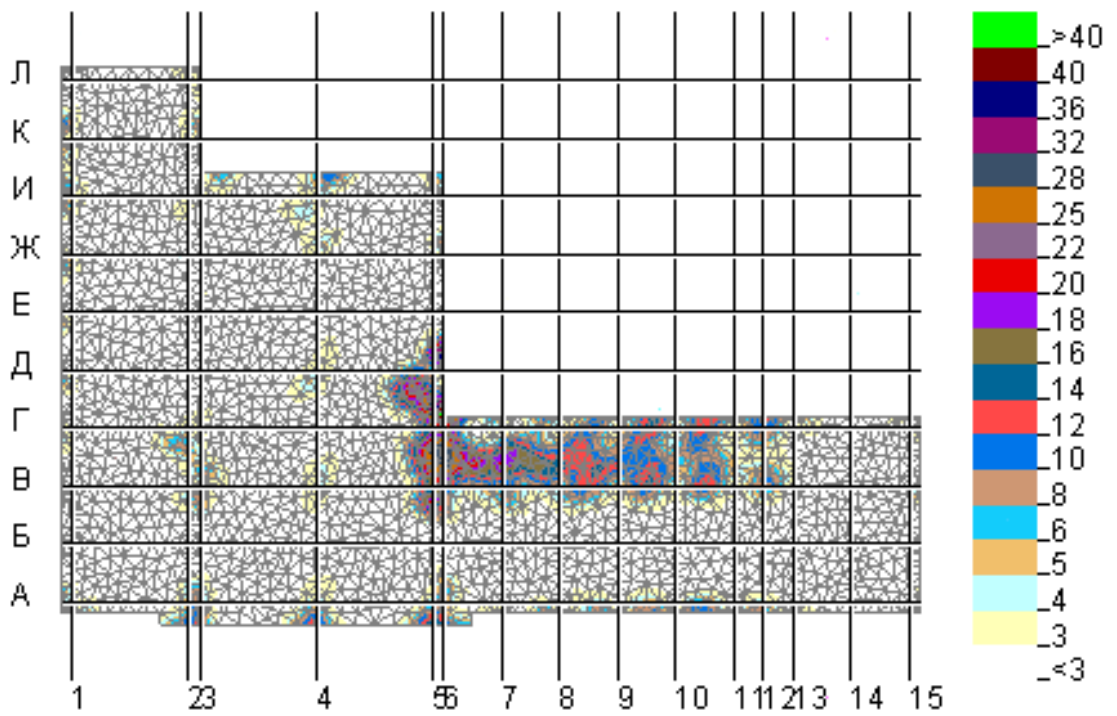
Армування нижньої зони плити вздовж осі ОУ
